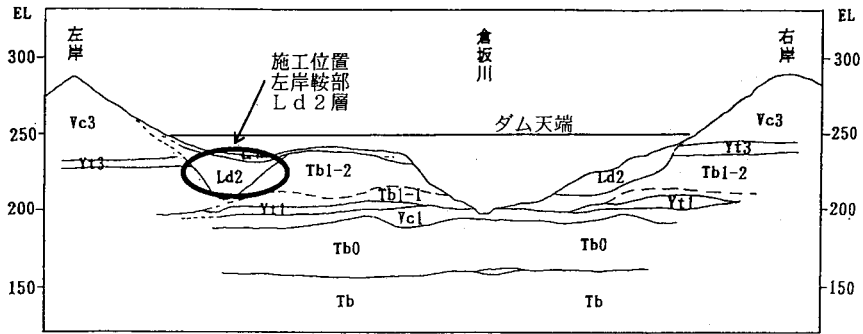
小田股ダム地質縦断面図と連続地中壁施工位置
